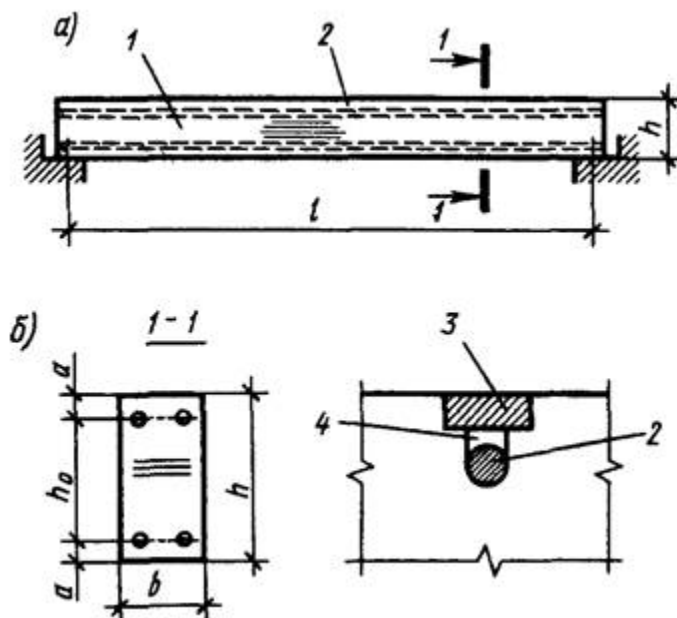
Клесармована балка: а – фасад; б – січення; 1 – клеєдерев'яна балка; 2 – сталеві арматури; 3 – рейка; 4 – паз
